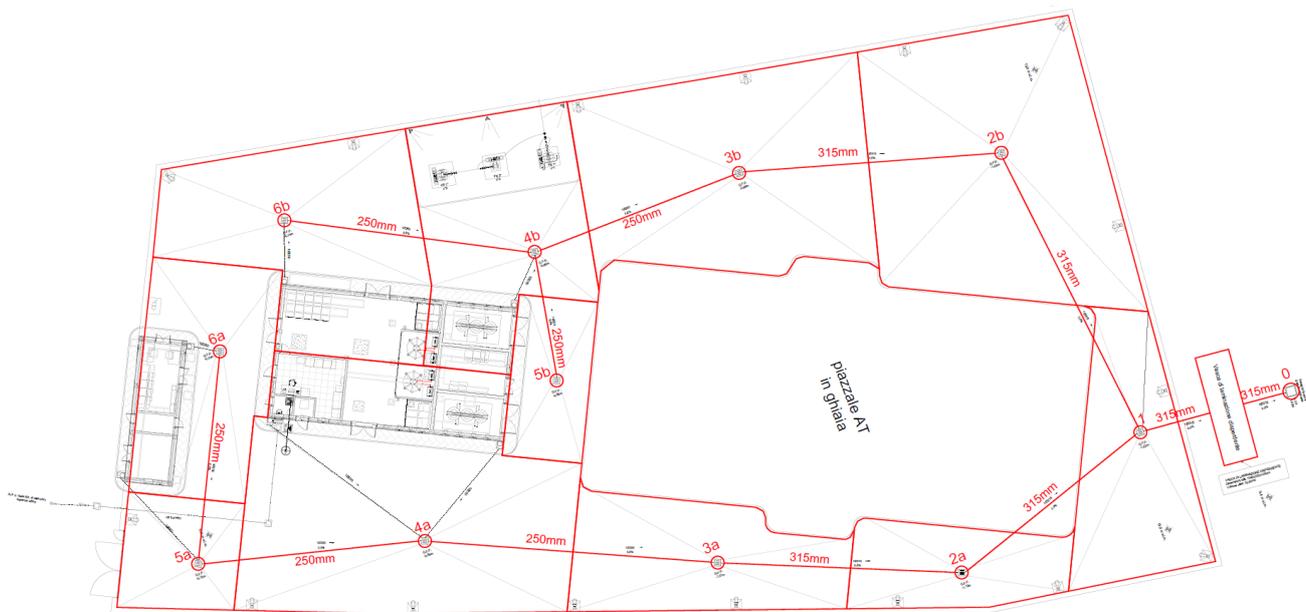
Stralcio planimetrico della rete di drenaggio adottata per il piazzale.
